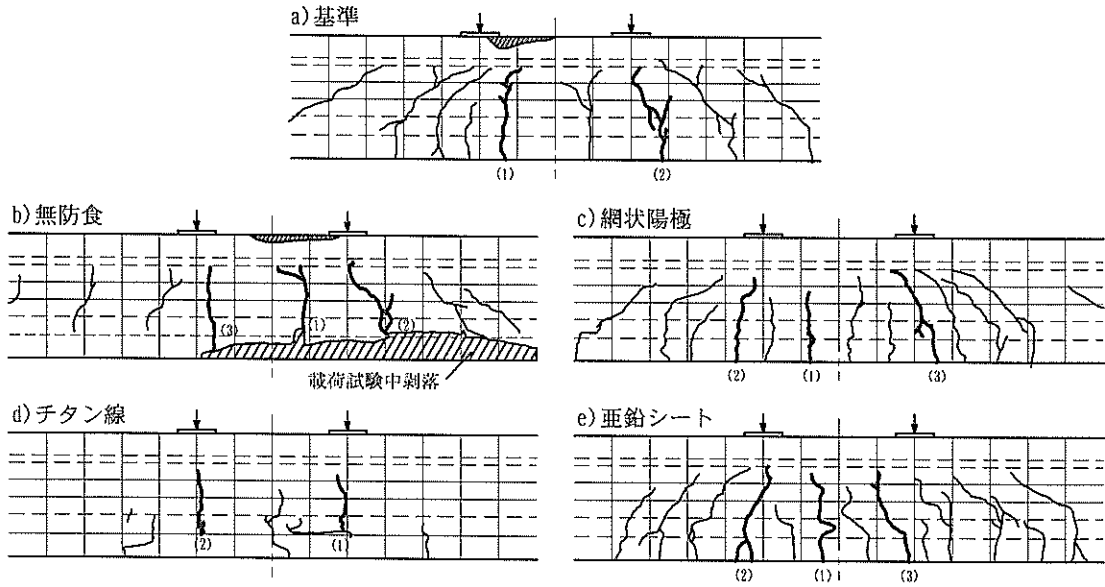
ひび割れ分散性状 (大型はり供試体)
